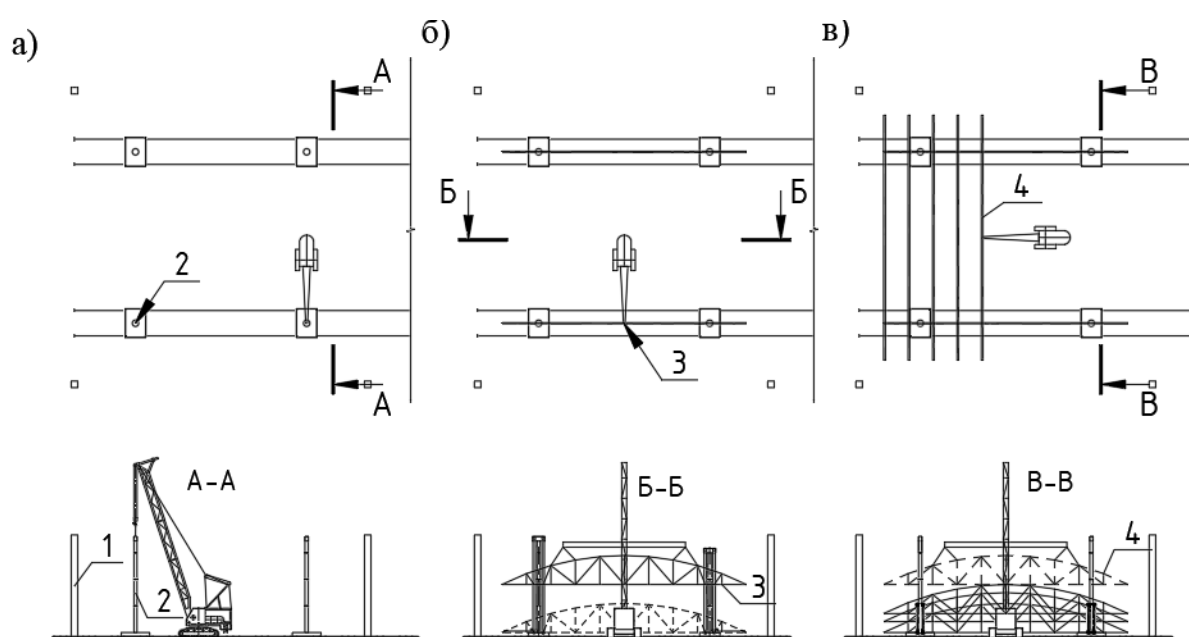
Установка передвижного кондуктора для монтажа железобетонных оболочек двойной положительной гауссовой кривизны: а – монтаж опор на предварительно установленные пути; б – монтаж главных металлических ферм; в – установка кружальных прогонов; 1 – несущие колонны здания; 2 – опоры кондуктора; 3 – главные металлические фермы; 4 – кружальные фермы
